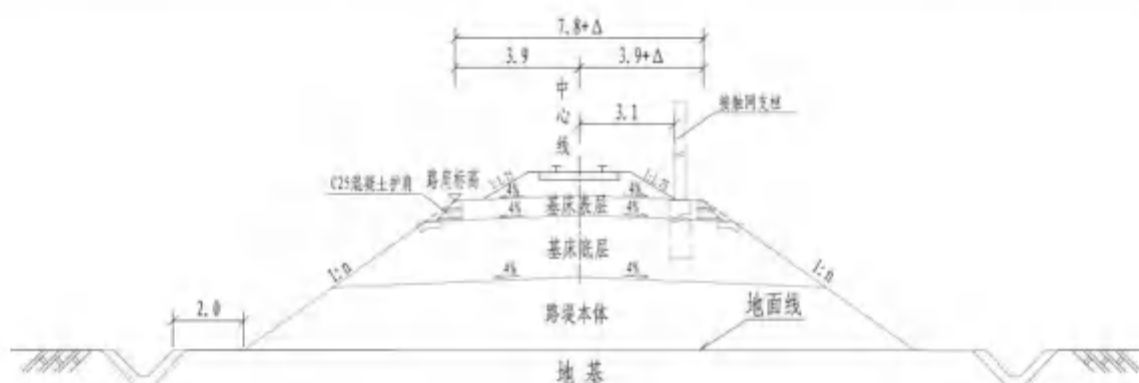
有砟轨道单线路堤标准横断面图
